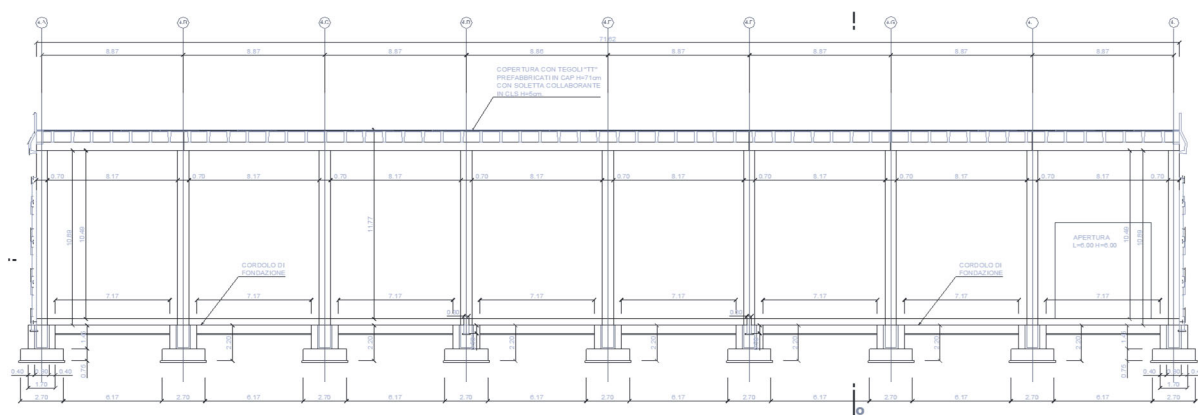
SCHEMA TIPICO STRUTTURA PREFABBRICATA A TELAIO
